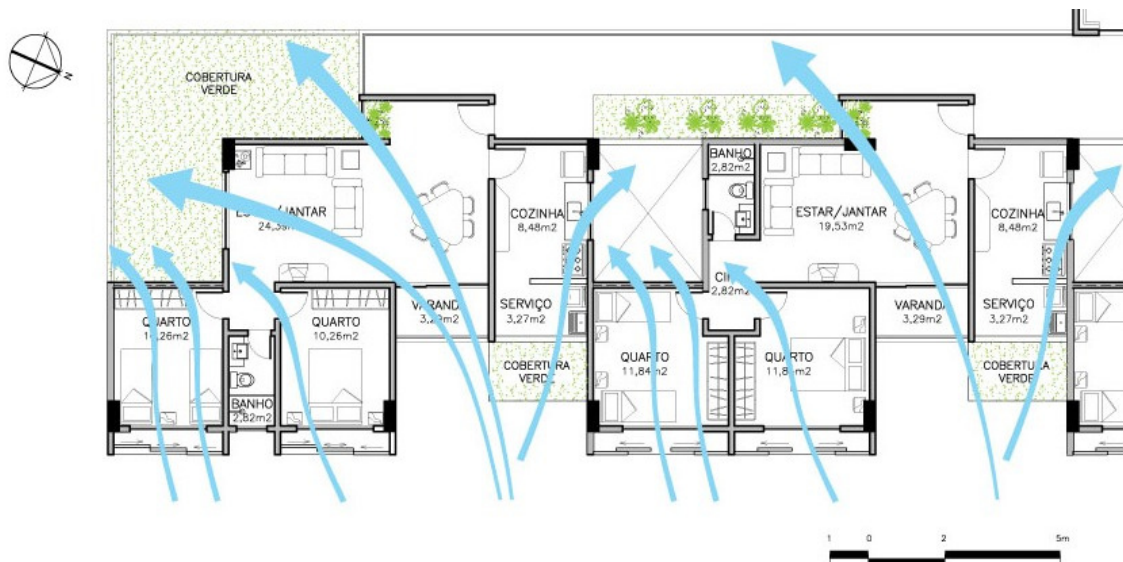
Seção da planta baixa do pavimento tipo do Bloco 1. Fonte: FANTICELE; ALVAREZ, 2008.
